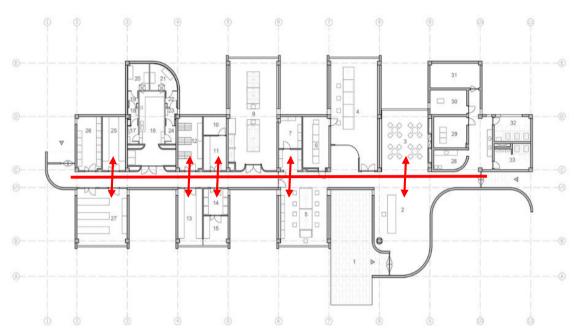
Laboratorio Planta de Sal, Primer Nivel
